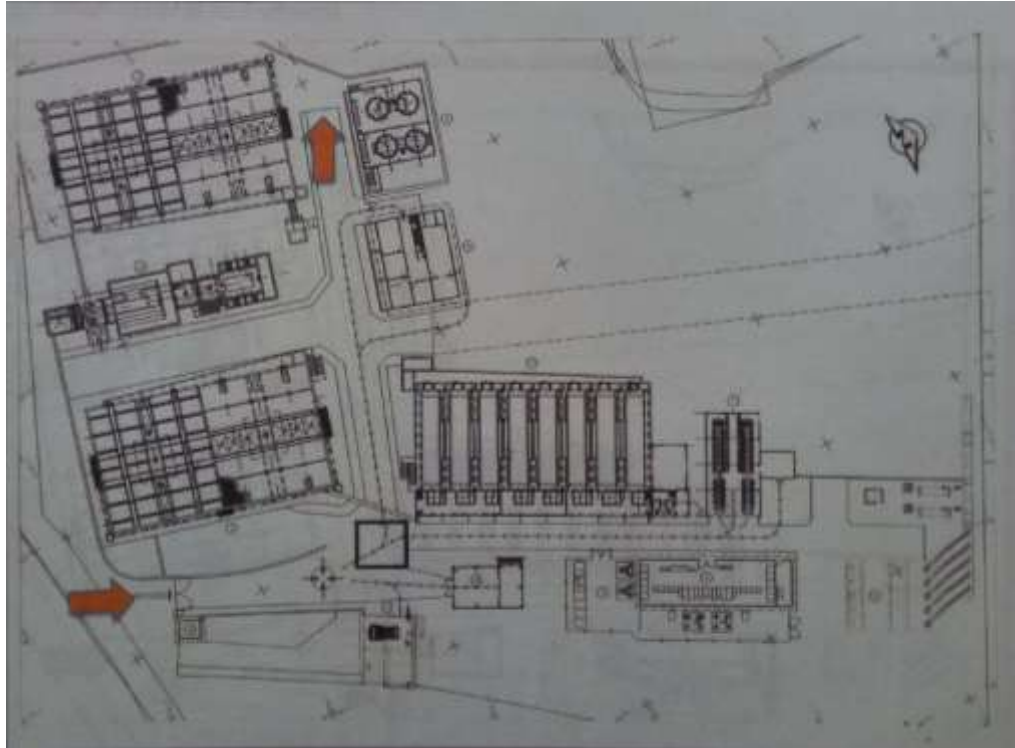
Plano de ubicación de la planta potabilizadora, ruta de acceso del camión y lugar de descarga.
